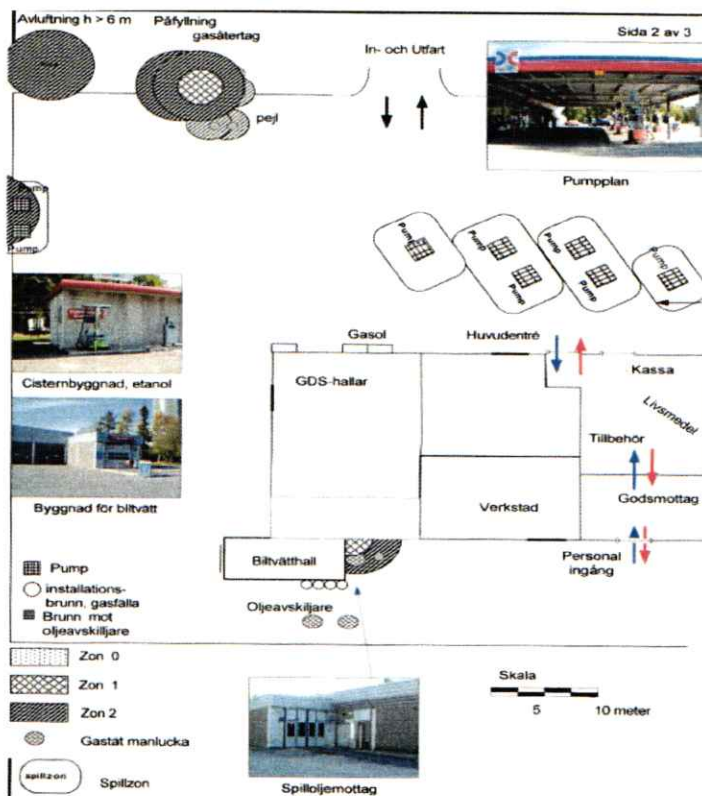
Klassningsplan över OK/Q8-stationen på Mineralvägen (9)
